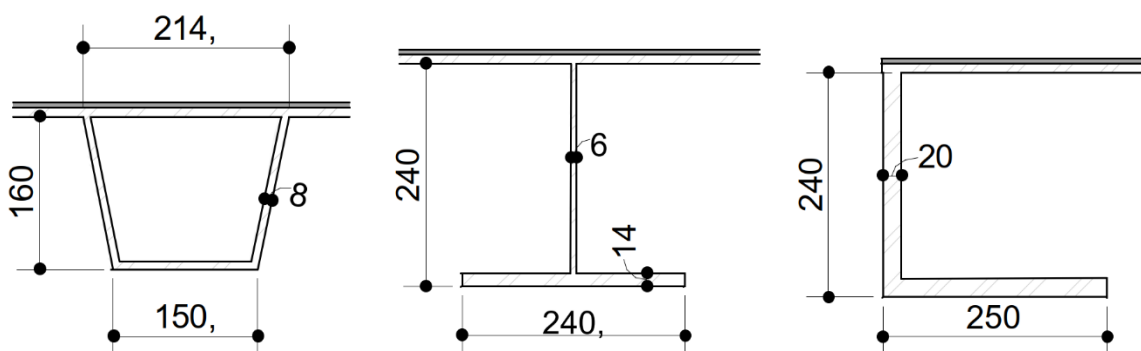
Détail des augets, du PRS central et de la poutre en L sur rive
